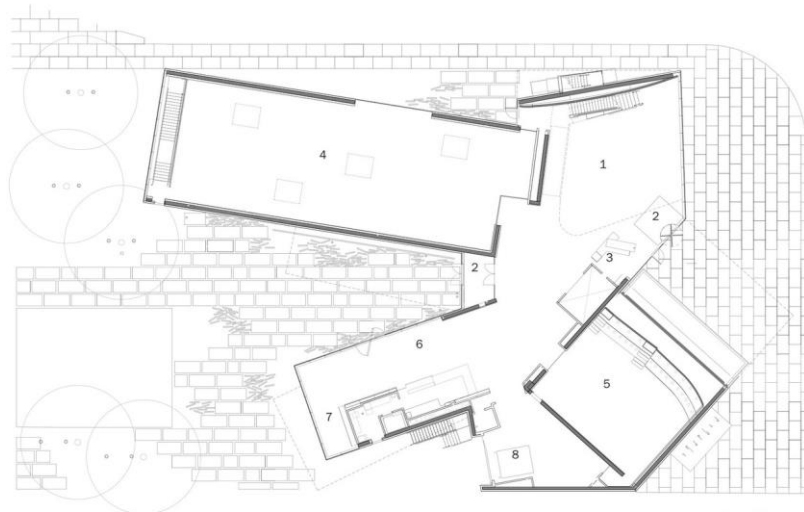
Planta. Institute for contemporary art, Fuente: Steven Holl architects
